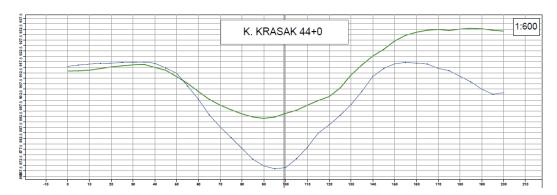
Tampilan Cross section 2 Sngai Krasak bagian tengah
